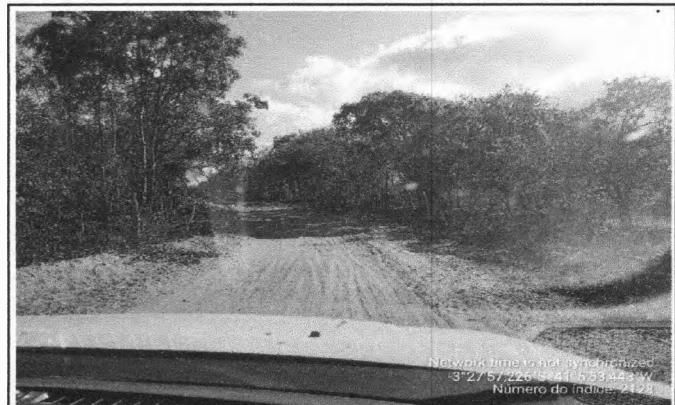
LOCAL DA CONSTRUÇÃO - BUEIRO
